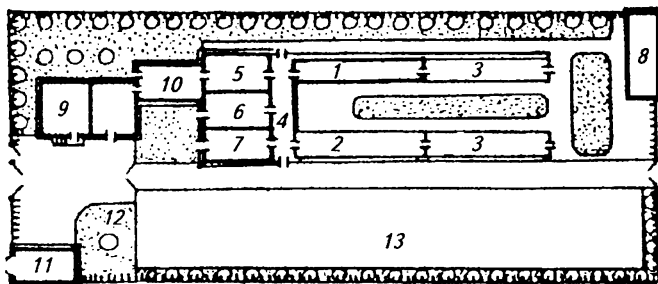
Генеральный план семейной кролиководческой фермы:
